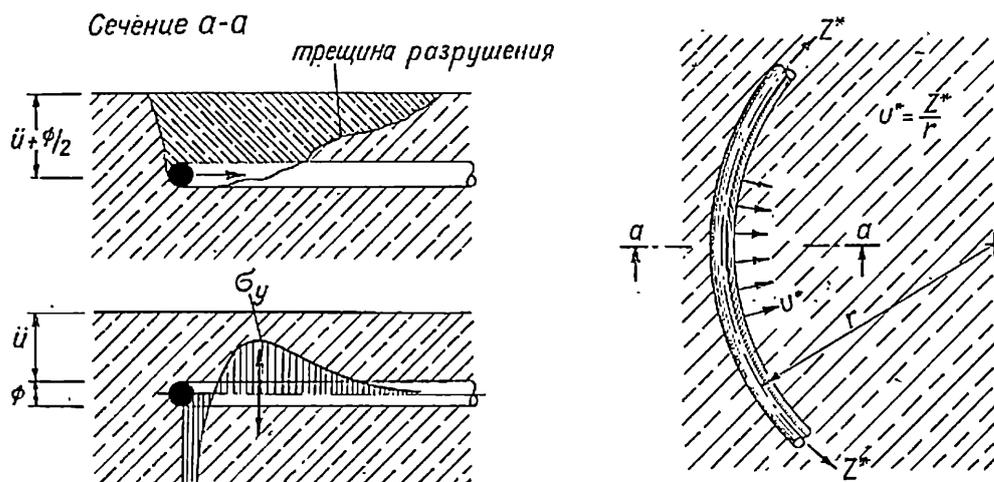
5. Поперечные растягивающие усилия, возникающие от усилий отрыва, могут привести к отколам защитного слоя у внешних стержней
